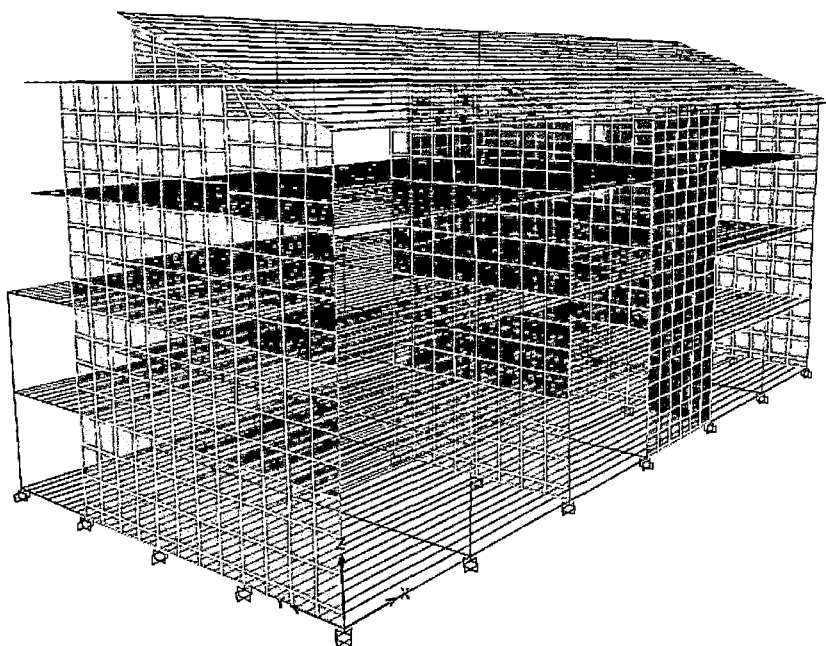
Modelamiento de estructura con losa adicional en la base
